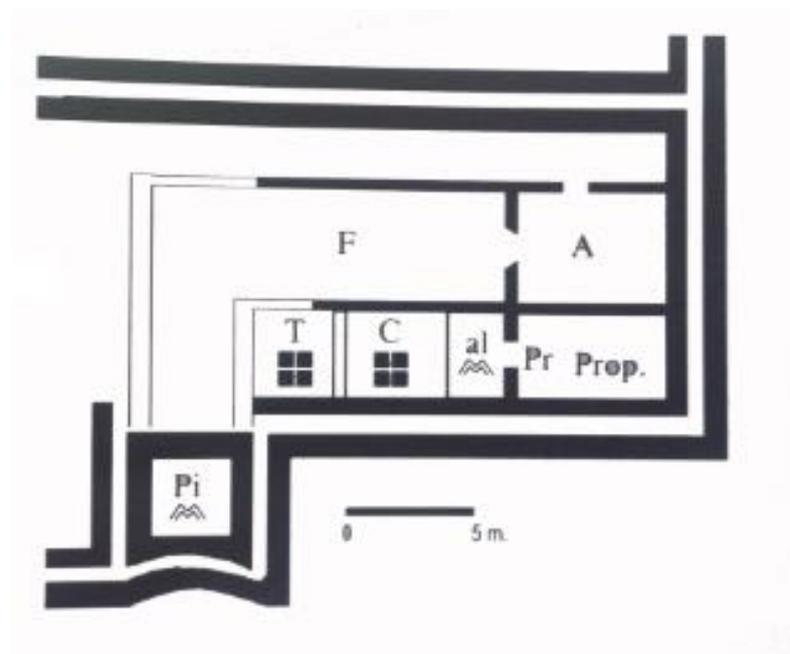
Planta de las termas de la villa romana de Puelles (García- Entero, 2006)
